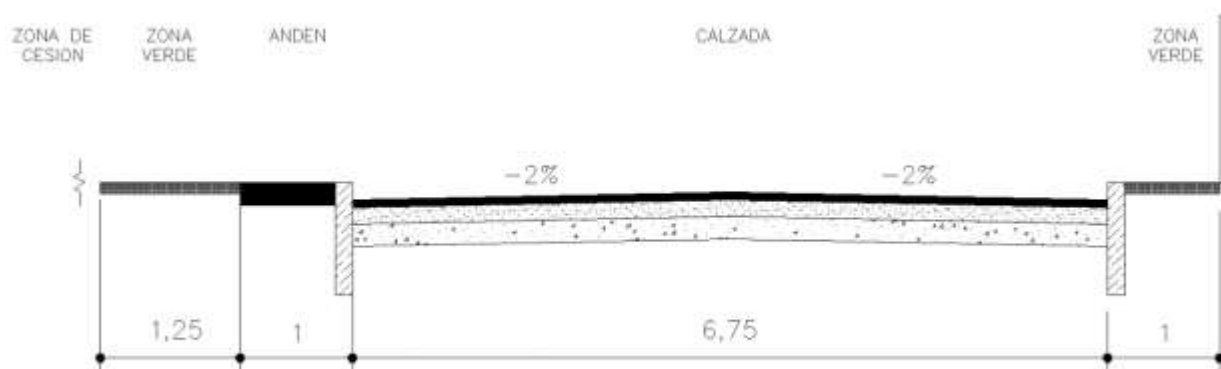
Sección Transversal Típica. Fuente: Elaboración propia
